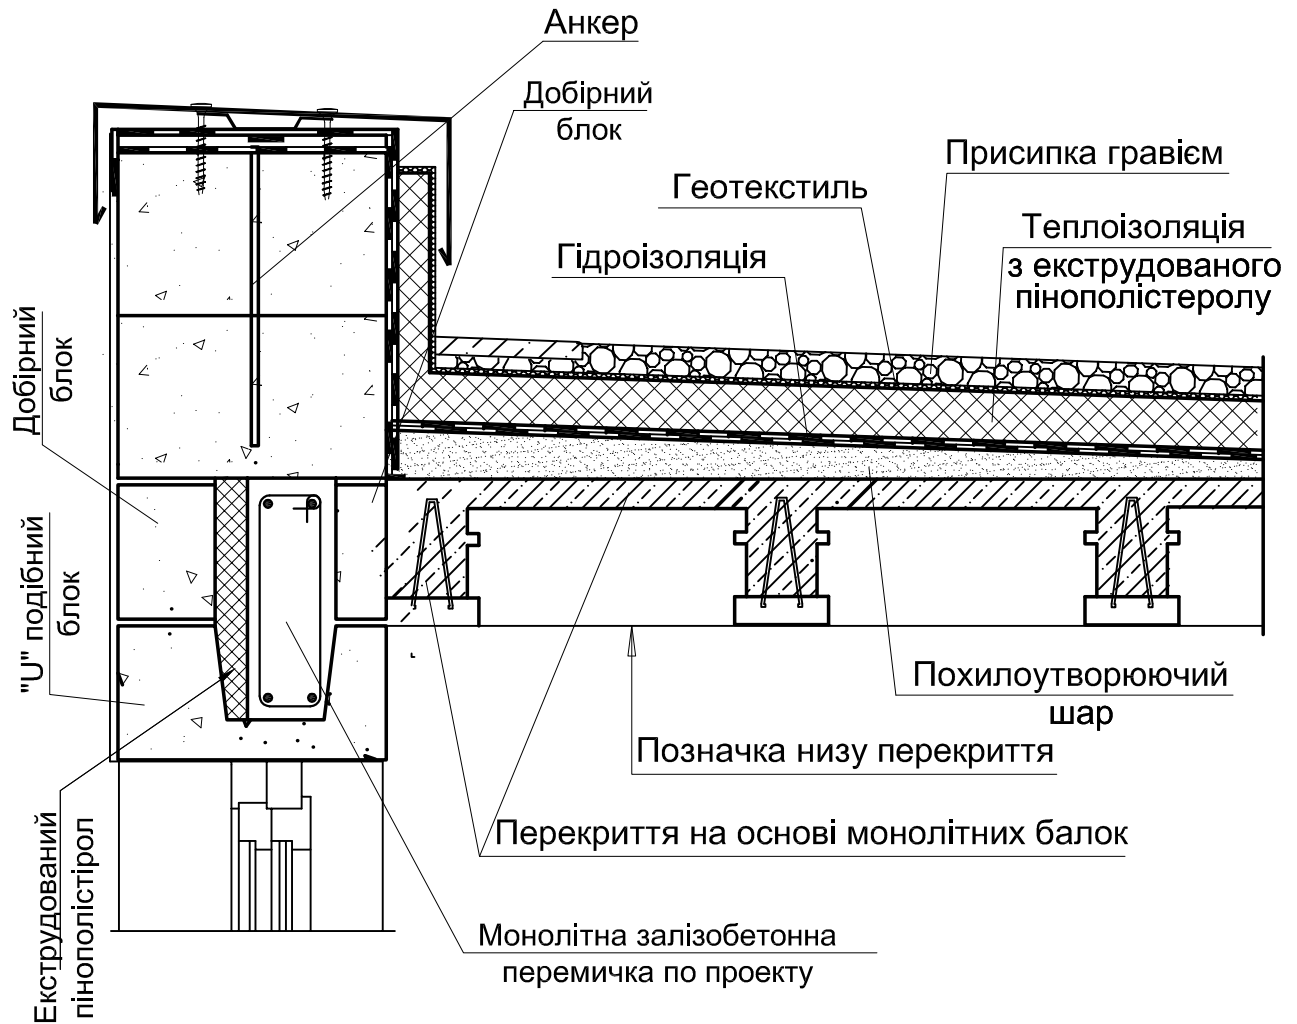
Конструювання утепленого плоского даху над збірно-монолітним дрібноштучним перекриттям даху. Проекція поперек несучих балок
